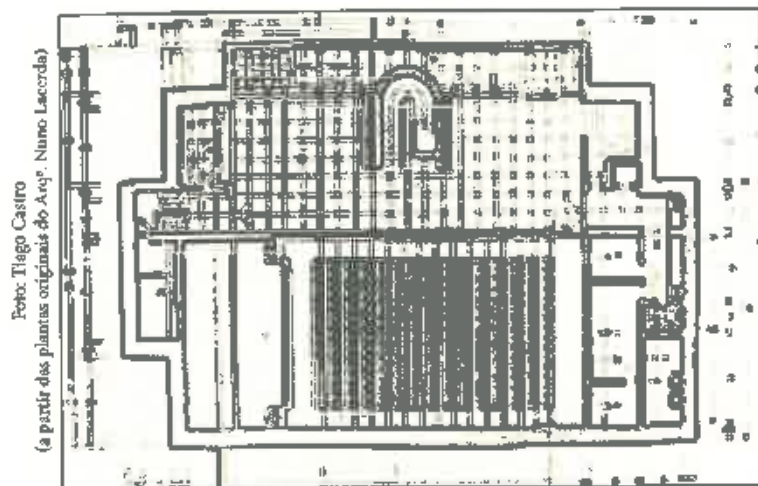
Planta do piso 2: Foyer e auditório - Projecto de Reconstrução da autoria do Arq.º Nuno Lacerda Lopes (1997).
